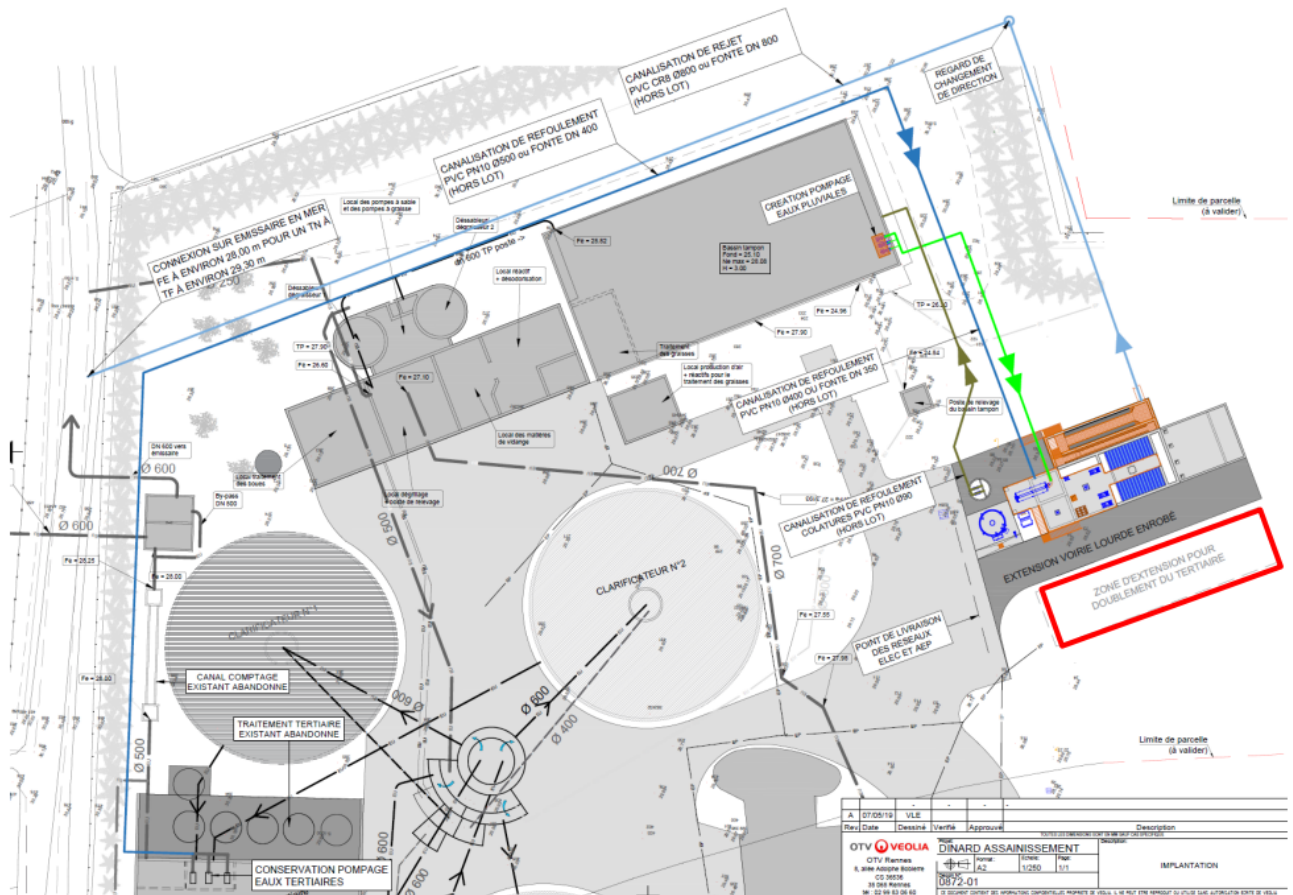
Extrait du plan d'implantation (source : Veolia – OTV)
